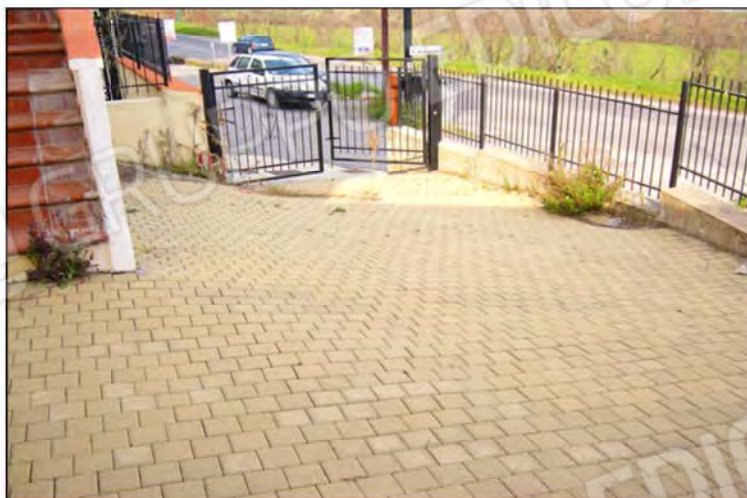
fabbricato di Via B. Croce – Part. n°1033)
